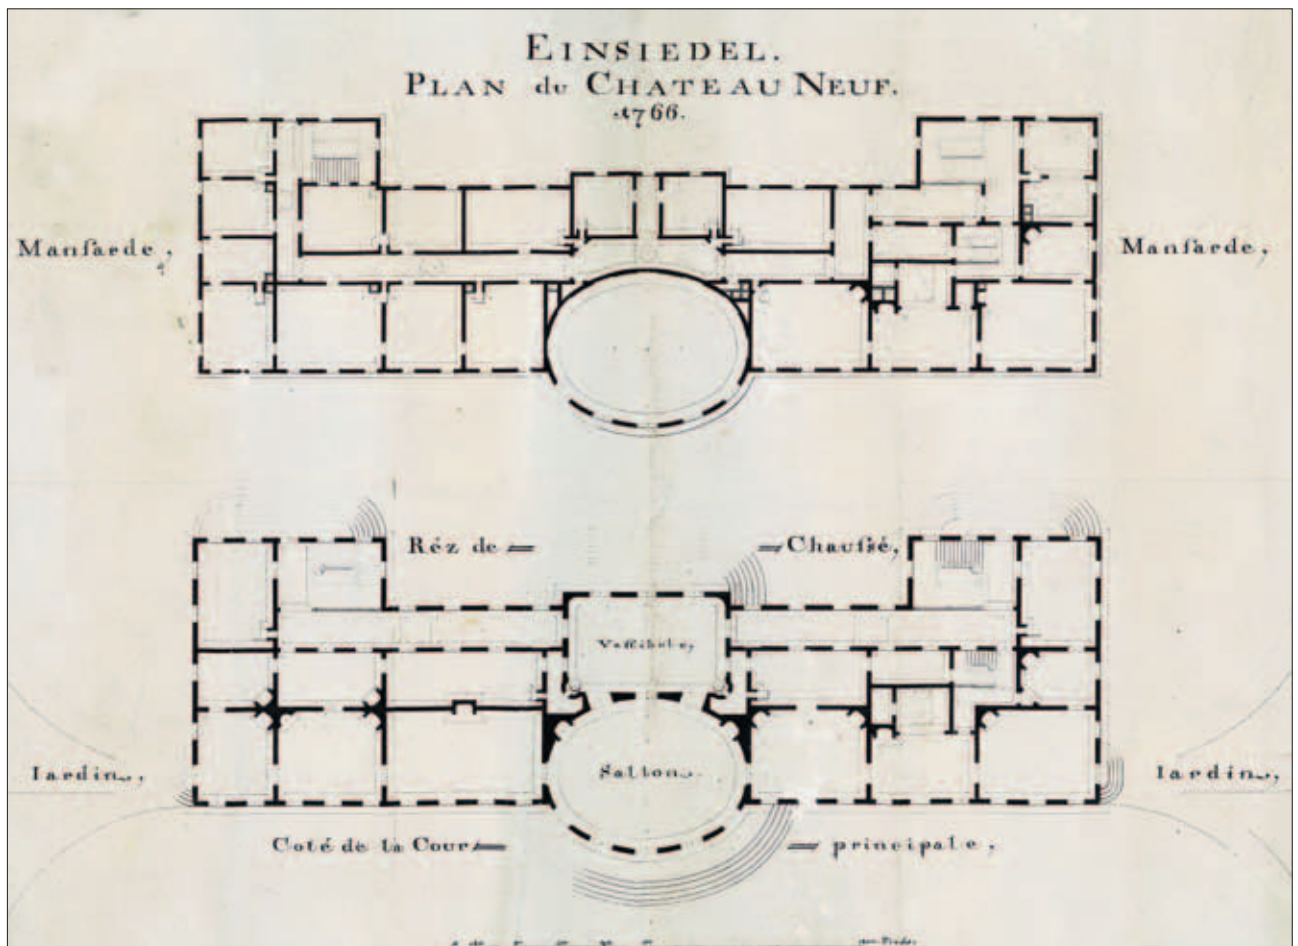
Der mit „Einsiedel. Plan du Château Neuf 1766“ bezeichnete Plan zeigt die Grundrisse des Erdgeschosses (unten) und Mansardgeschosses (oben). Südosten ist oben.
